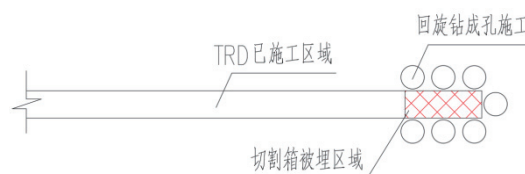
回旋钻机GPS-20辅助起拔施工平面示意图
